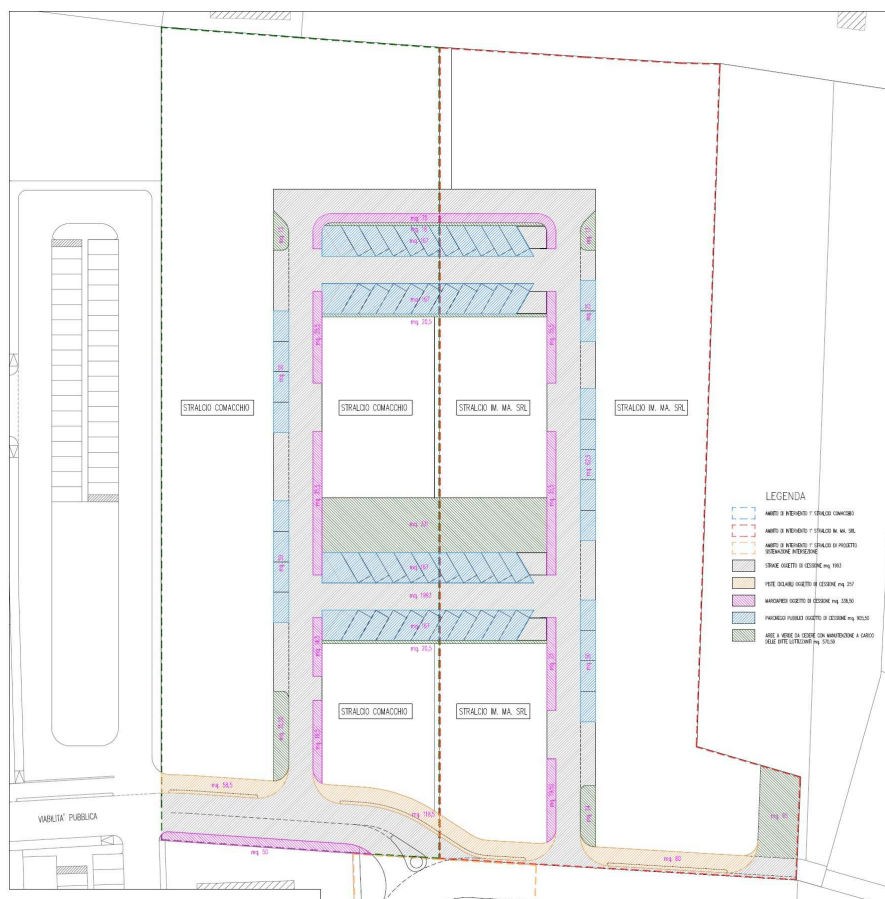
Estratto elaborato 23.4D.2 Planimetria generale – aree oggetto di cessione
